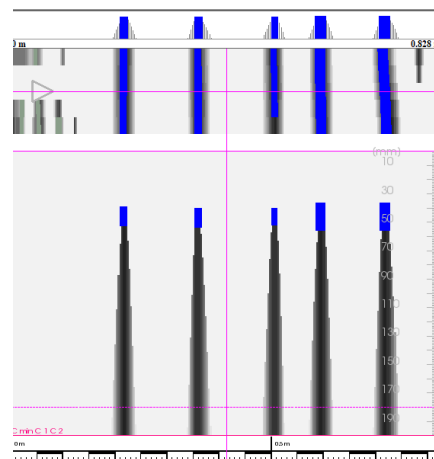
Poutre Pt04 – Travée 1 côté C0
